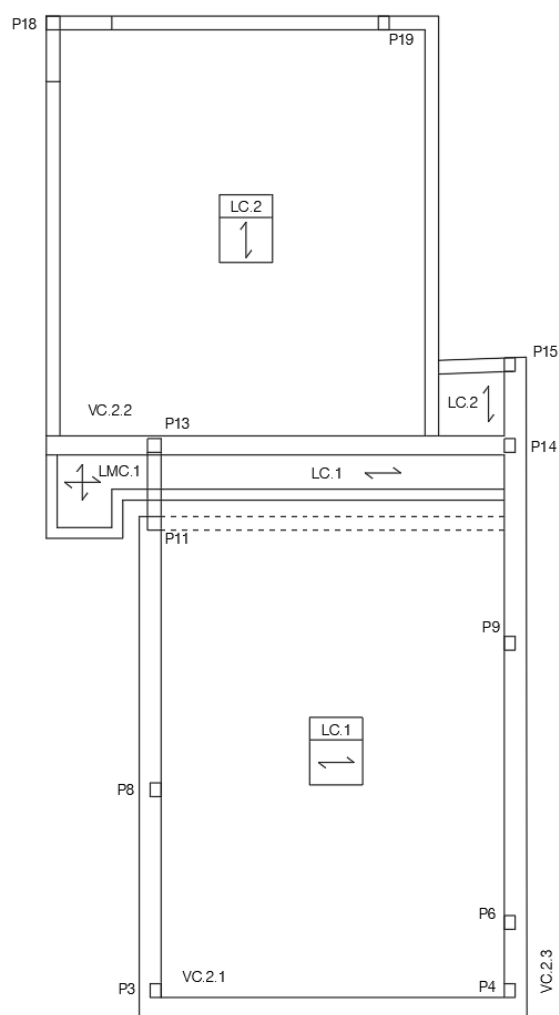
Esquema estrutural da cobertura (Projeto de estruturas).
